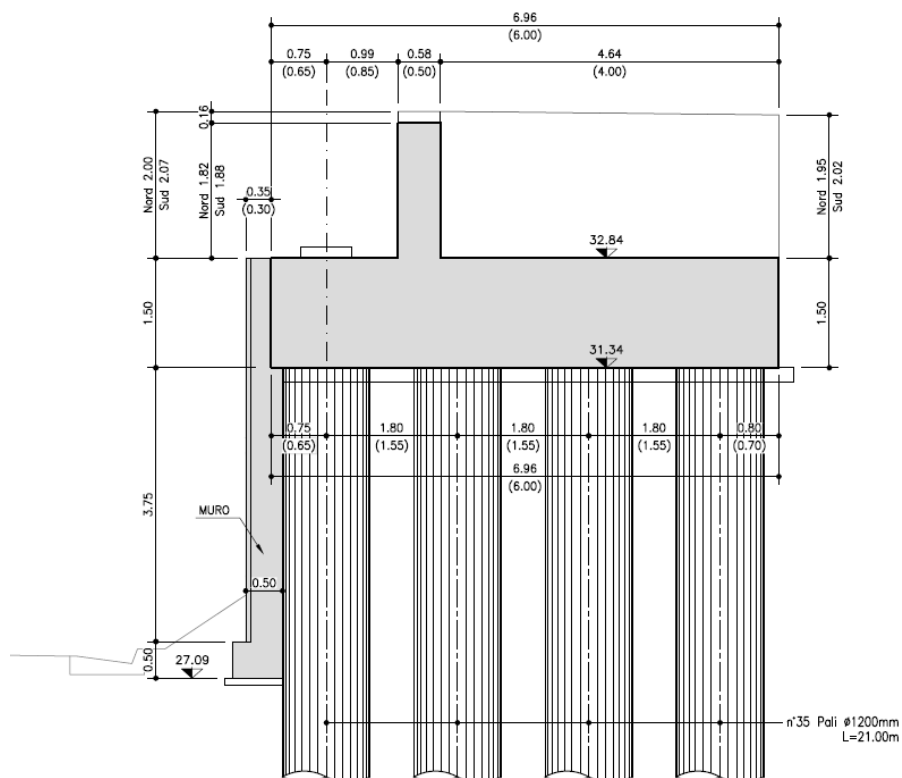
Sezione trasversale della Spalla B
